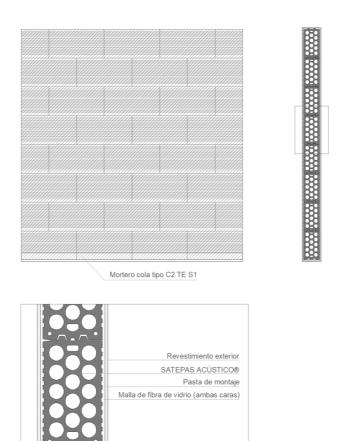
Alzado, sección transversal y detalle de peto con malla de fibra de vidrio
